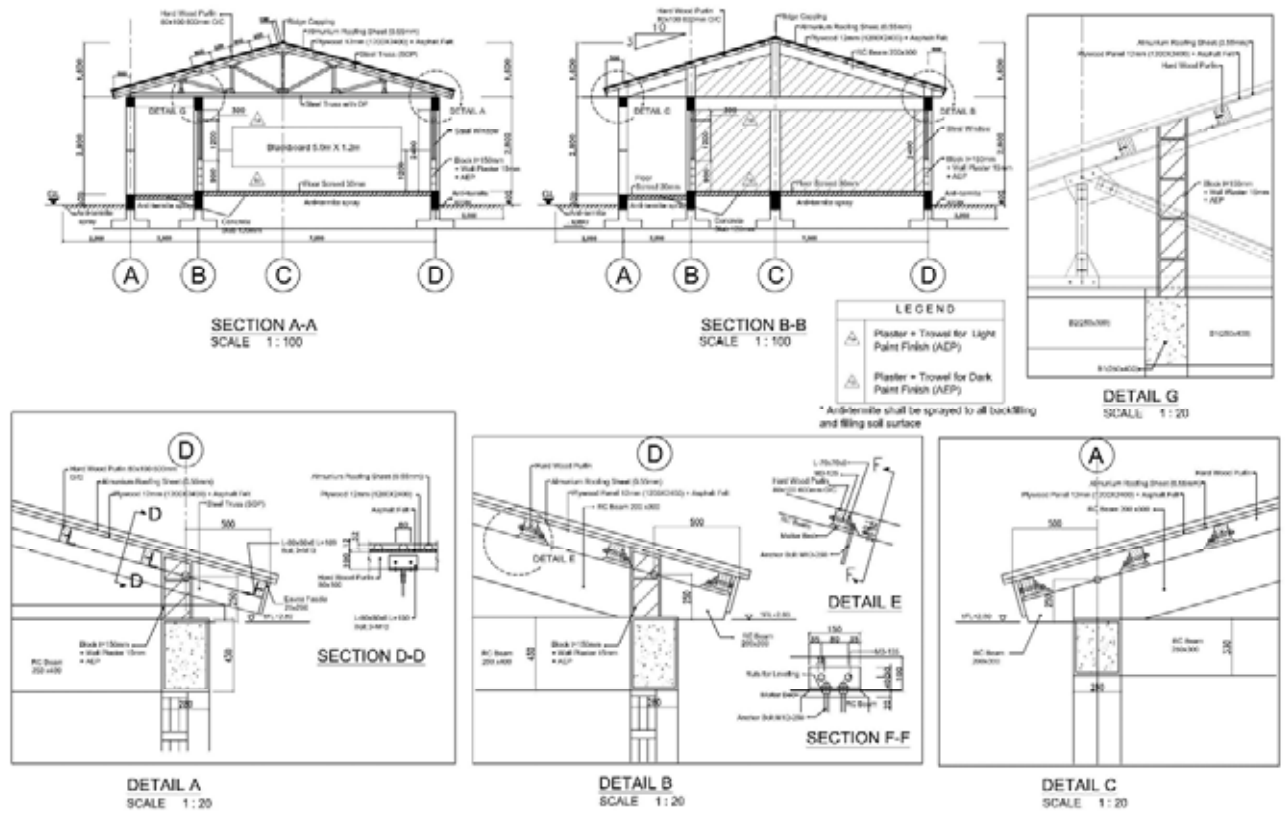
断面図 (鉄骨トラス部及びコンクリートトラス部) 及び屋根詳細図 (共通)
